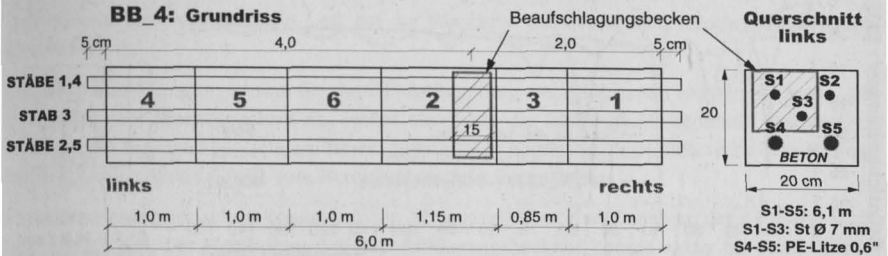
Versuch *BB_4*: Grundriss und Querschnitt des Versuchskörpers mit Stabanordnung, Lage des Beaufschlagungsbeckens sowie Länge und Reihenfolge der Betonierabschnitte
